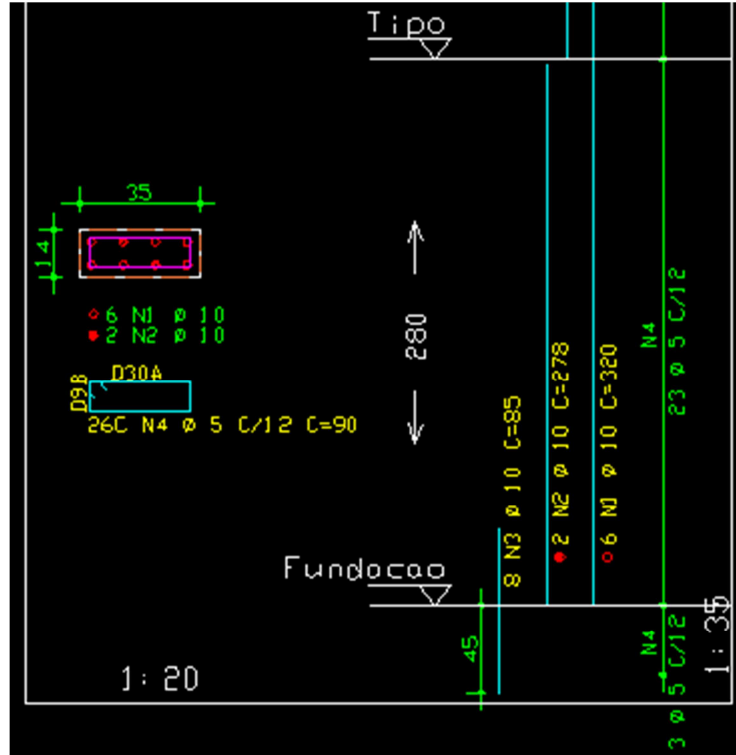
Detalhamento das armaduras de aço do Pilar 9 após da aplicação do SISE.
